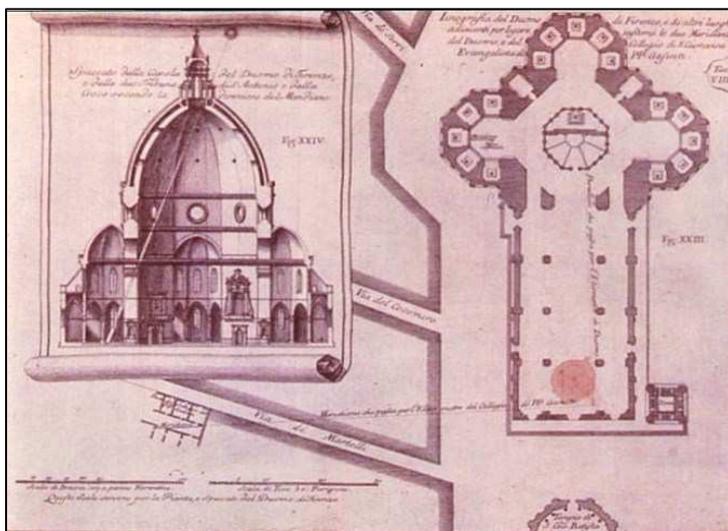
Meridiana del Toscanelli (1467). Sezione e pianta (dal Web)
